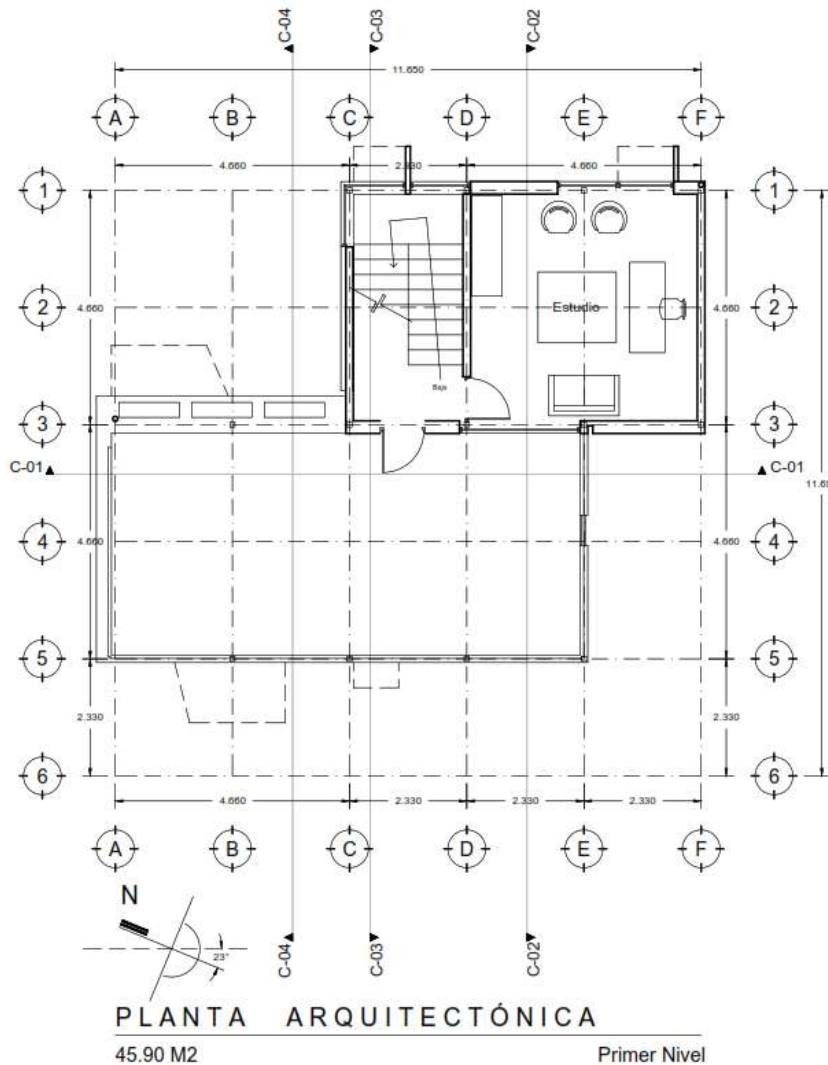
Planta arquitectónica casa solar experimental (Dibujo hecho en AutoCAD 16 por el autor).
